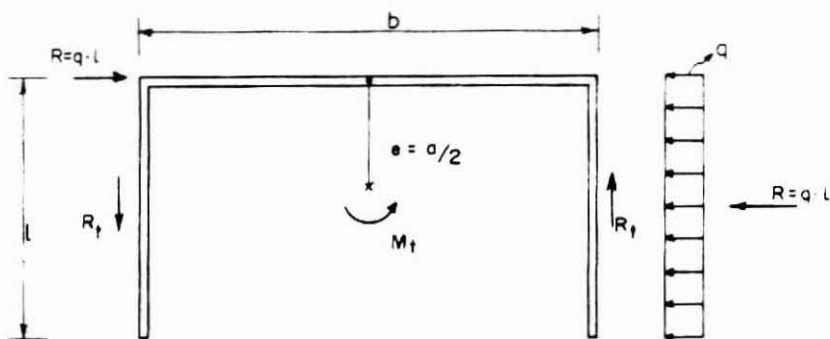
Diafragma horizontal apoyado en un muro con vano.
